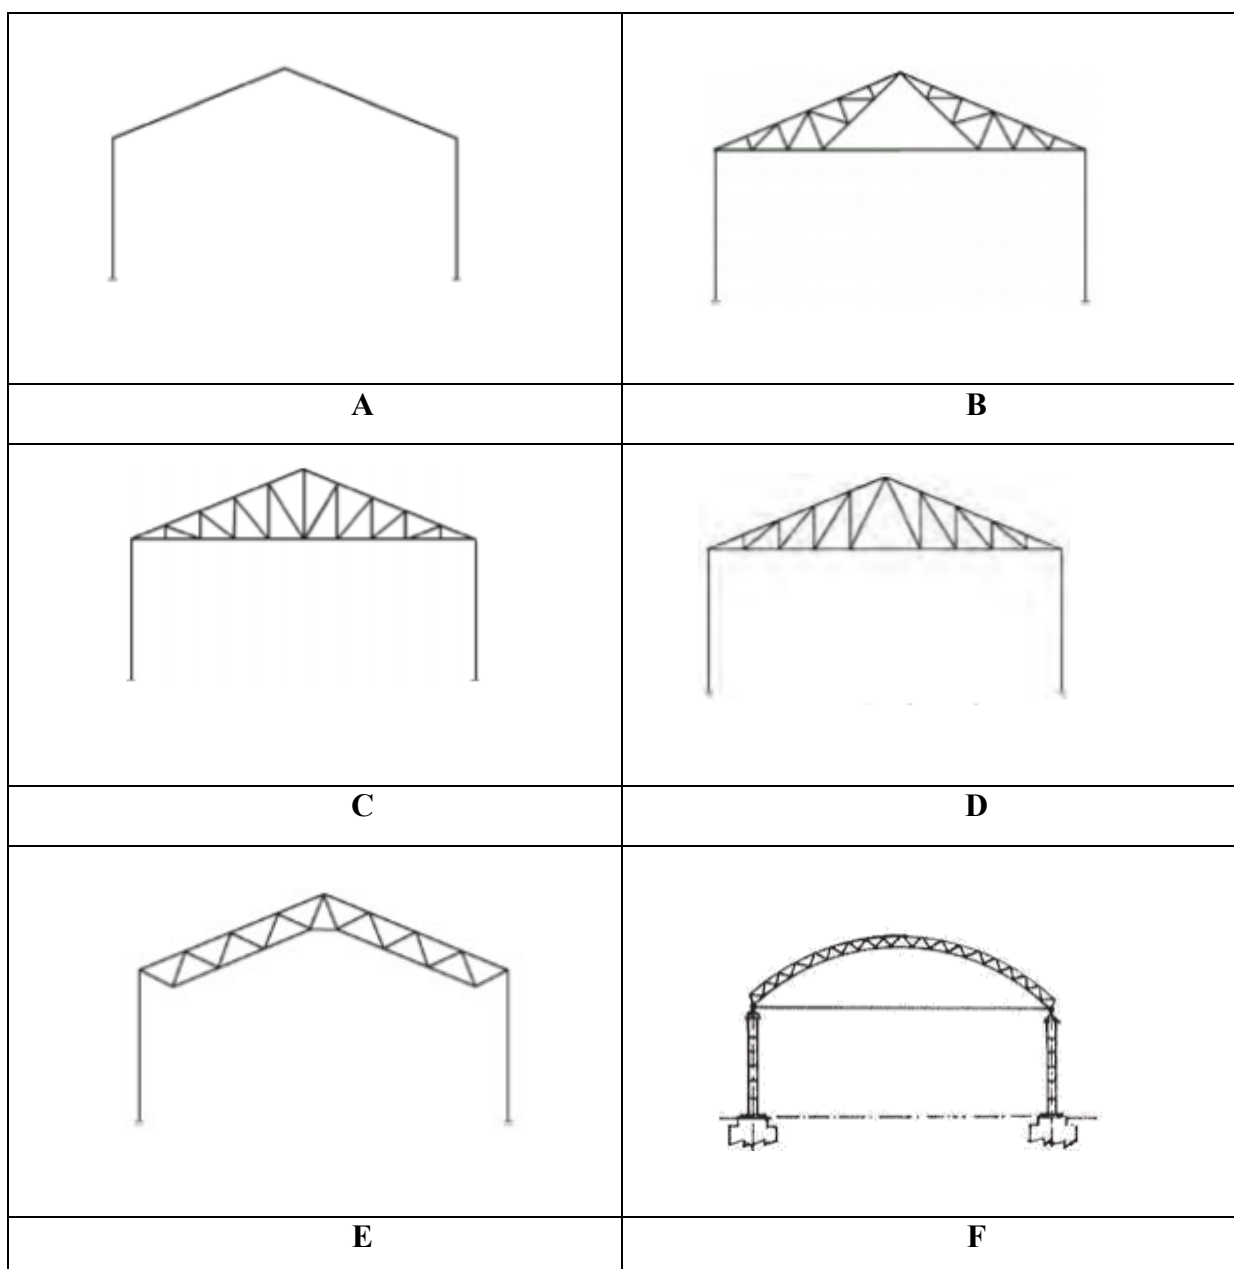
Tipos de pórticos, A Pórtico Rígido, B Palonceu Recta, C Cercha Americana, D cercha inglesa, E viga en celosía, F Pórtico mixto con forma de arco
